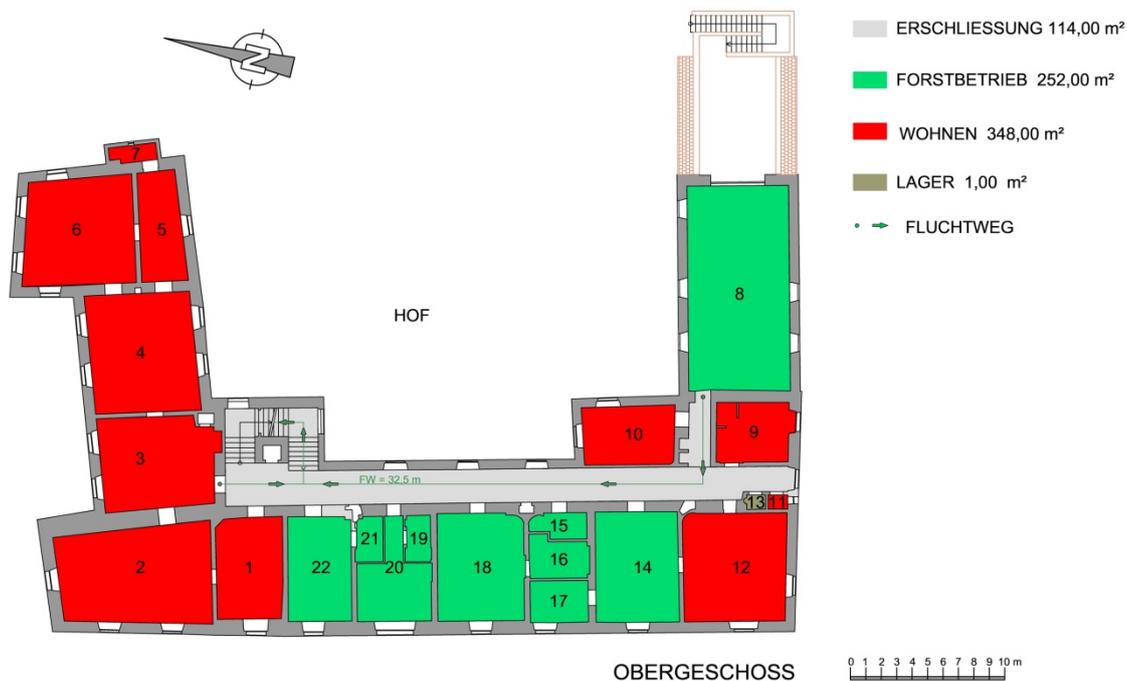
zeigt den Grundriss des Schlosses Großschweinbarth
